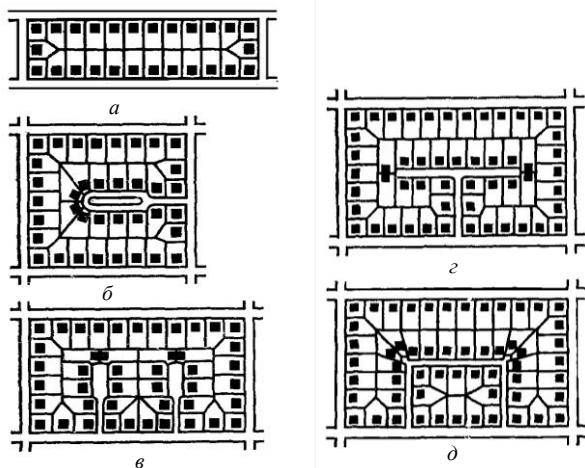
Схемы планировки сложных кварталов с усадебной застройкой:
